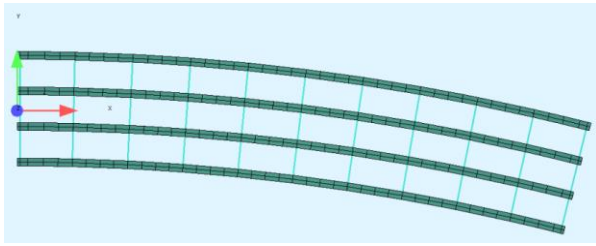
Vista en planta del modelo tridimensional de cálculo del vano 6 del puente 409.
